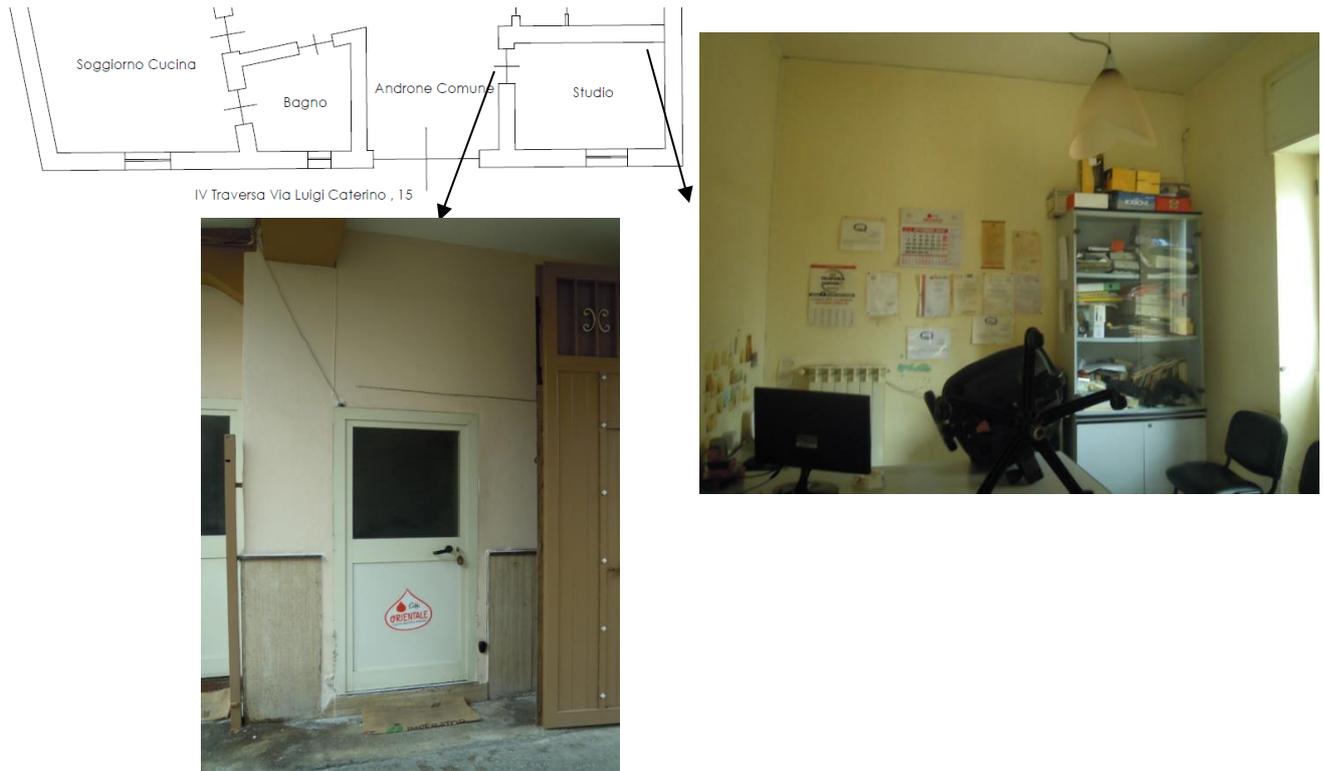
Individuazione fotografica del vano adibito a studio del bene oggetto di pignoramento.
